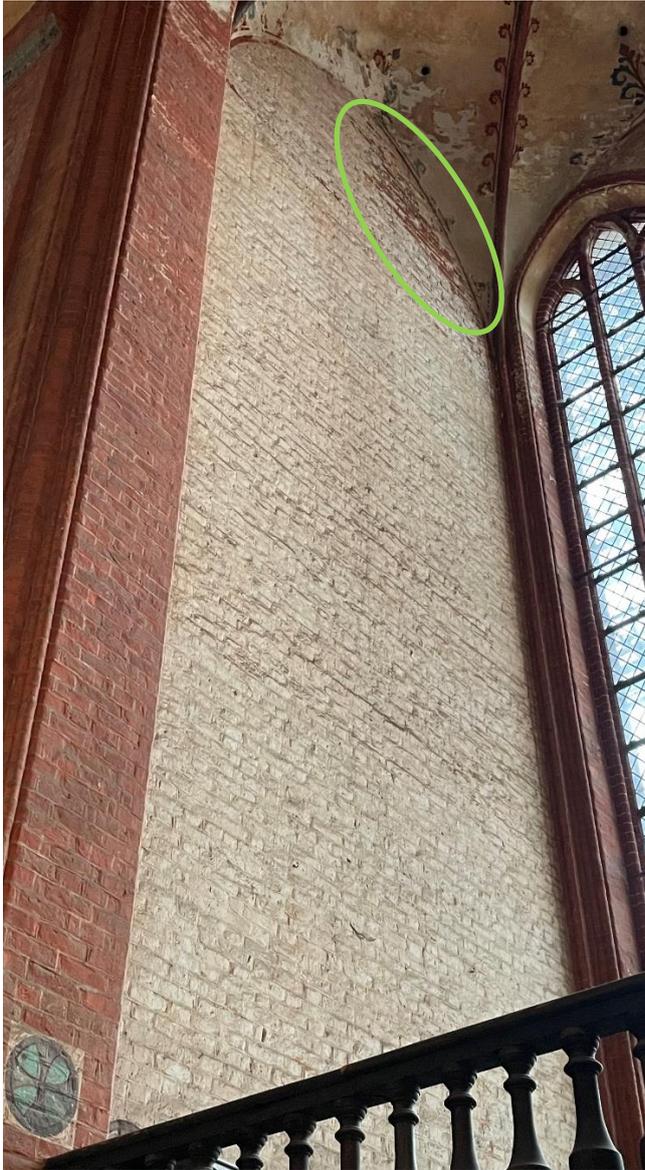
zu Punkt 2.4: Fassungsverlust Westwand und erhebliche Staubverschmutzung, Begleitstrich rudimentär.
